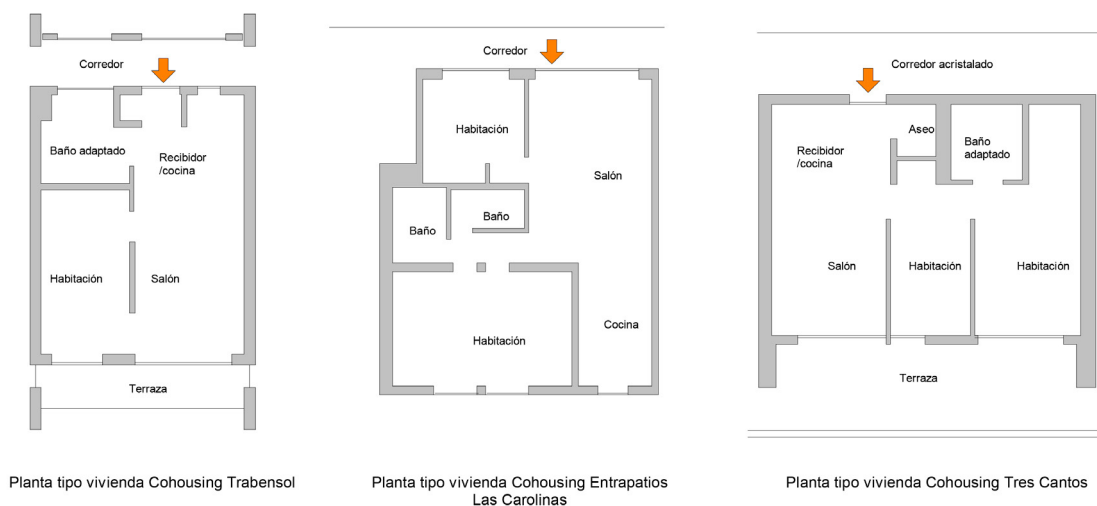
Esquemas de plantas tipo en cohousing Trabensol, Entrapatios Las Carolinas y Tres Cantos
